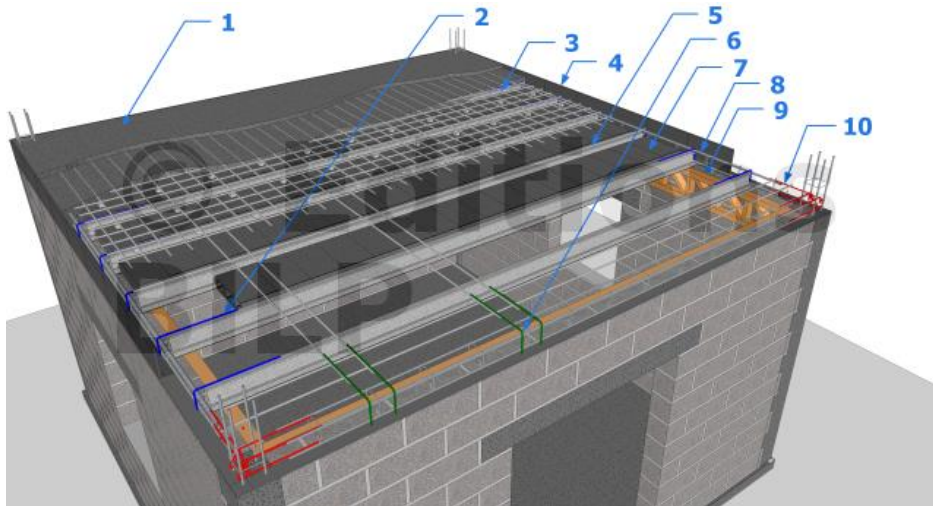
Schéma illustratif des éléments constitutifs d'un plancher à poutrelle et entrevous
